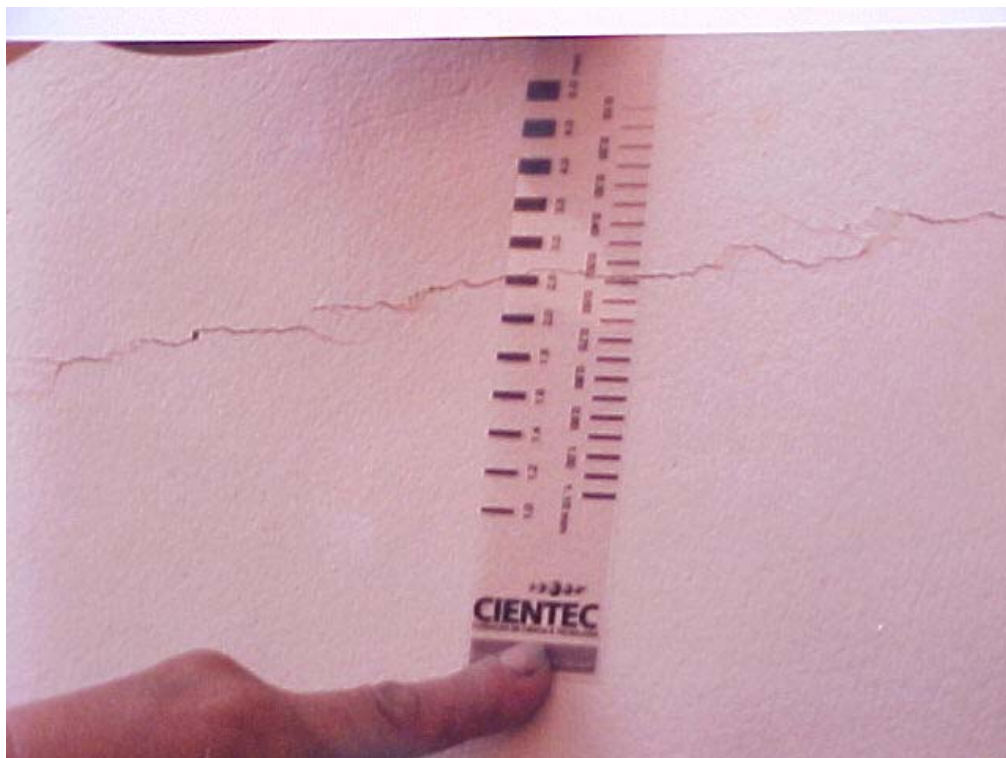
fissurômetro mostra a ordem de grandeza de uma fissura em parede
